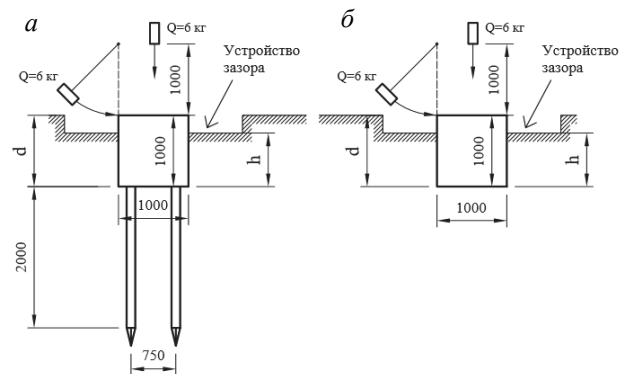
Схема опытных фундаментов Ф-1 (а) и Ф-2 (б):
